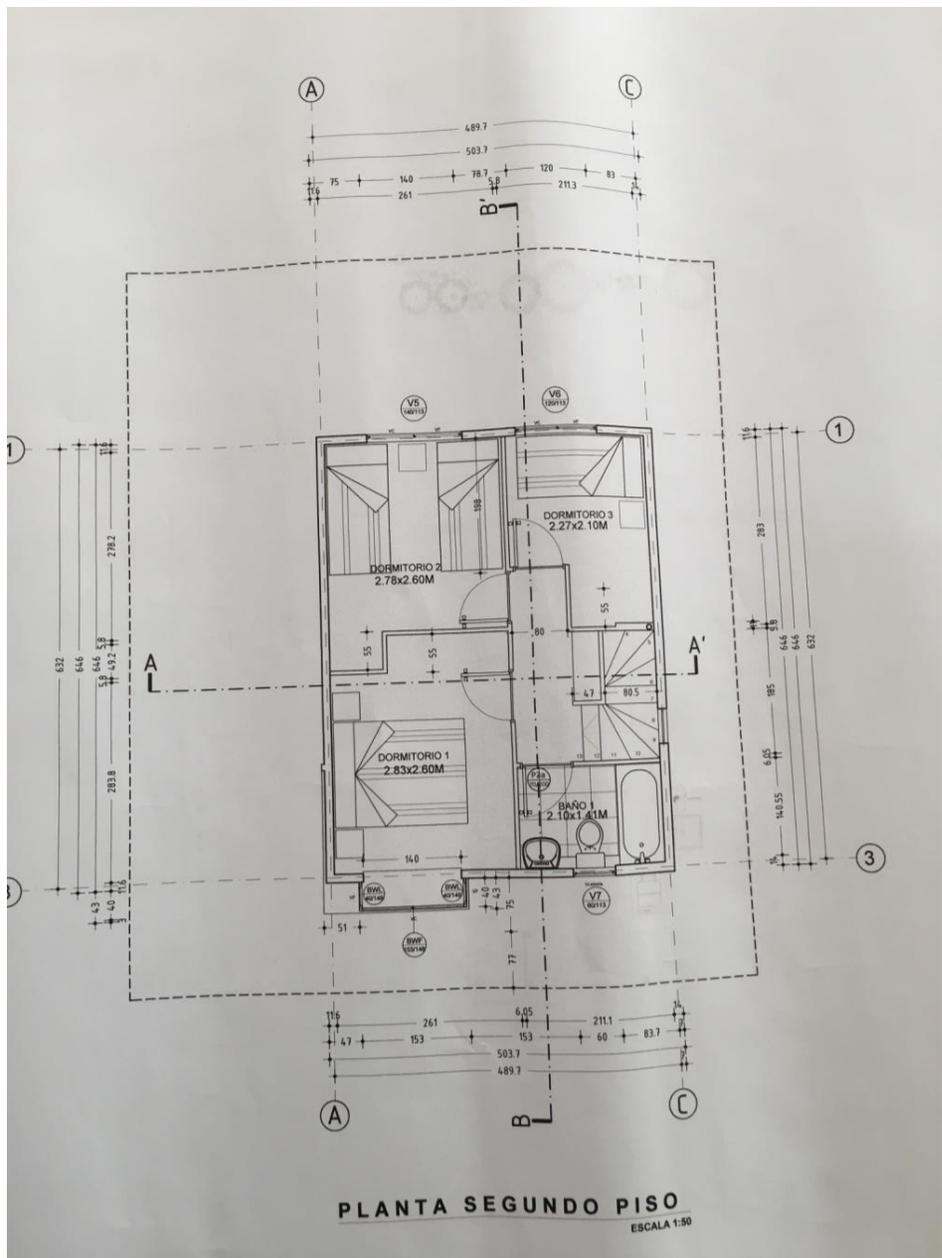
Planta Segundo Piso Casa Tipo C Aislada.
